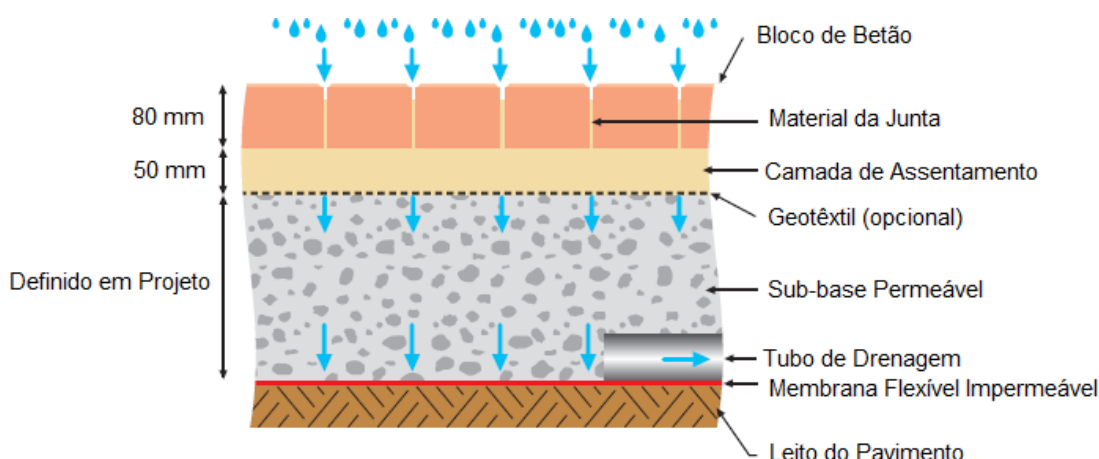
Pavimento permeável tipo C – Sem infiltração (INTERPAVE, 2010)
